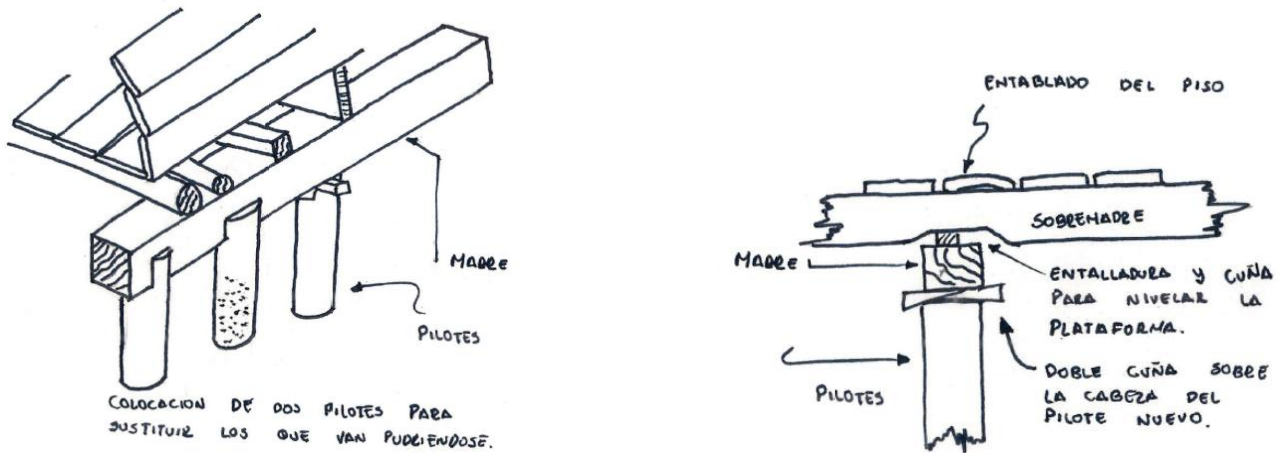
Detalle de la forma en la cual se remplazan los pilotes deteriorados y como se adhieren a la estructura existente.
